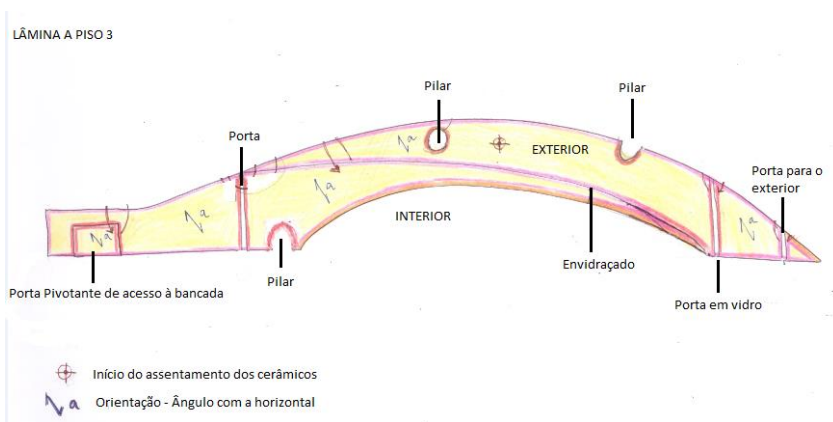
Alçado esquemático rebatido planificado do interior e exterior.
